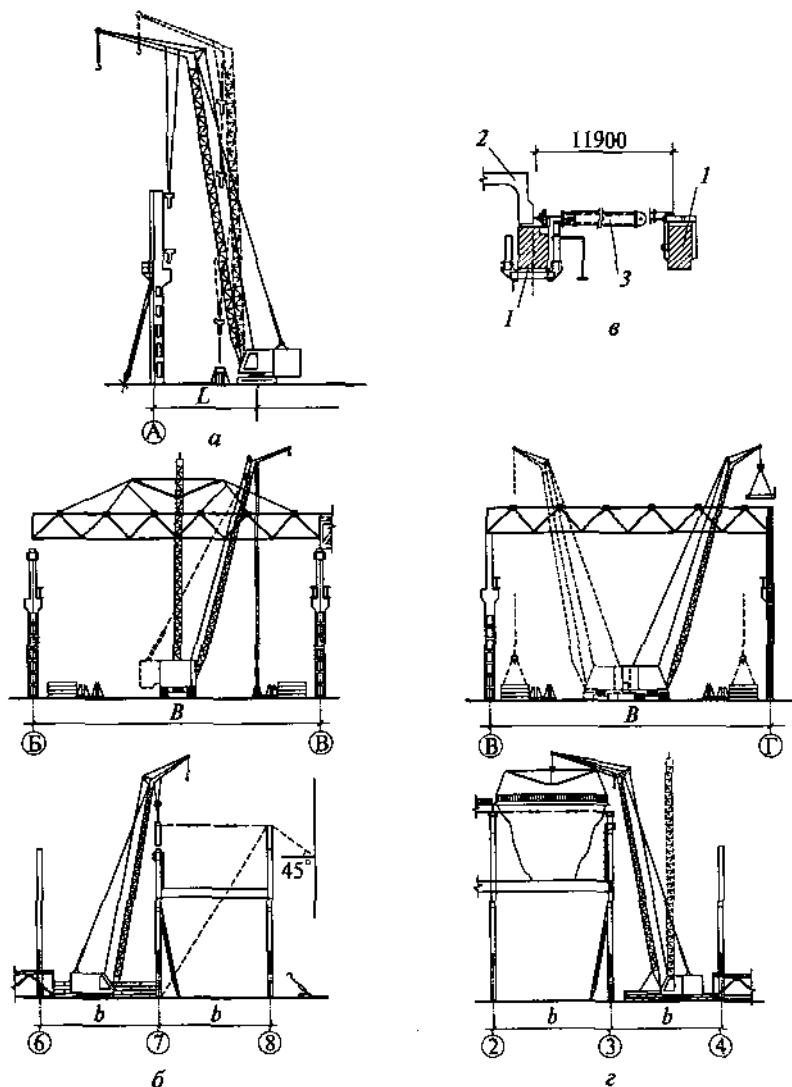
Схемы монтажа и временного крепления сборных элементов: *a* — подкрановой балки; *б, г* — фермы и плиты покрытия; *е* — узлы крепления распорки; *1* — ферма; *2* — плита покрытия; *3* — распорка
